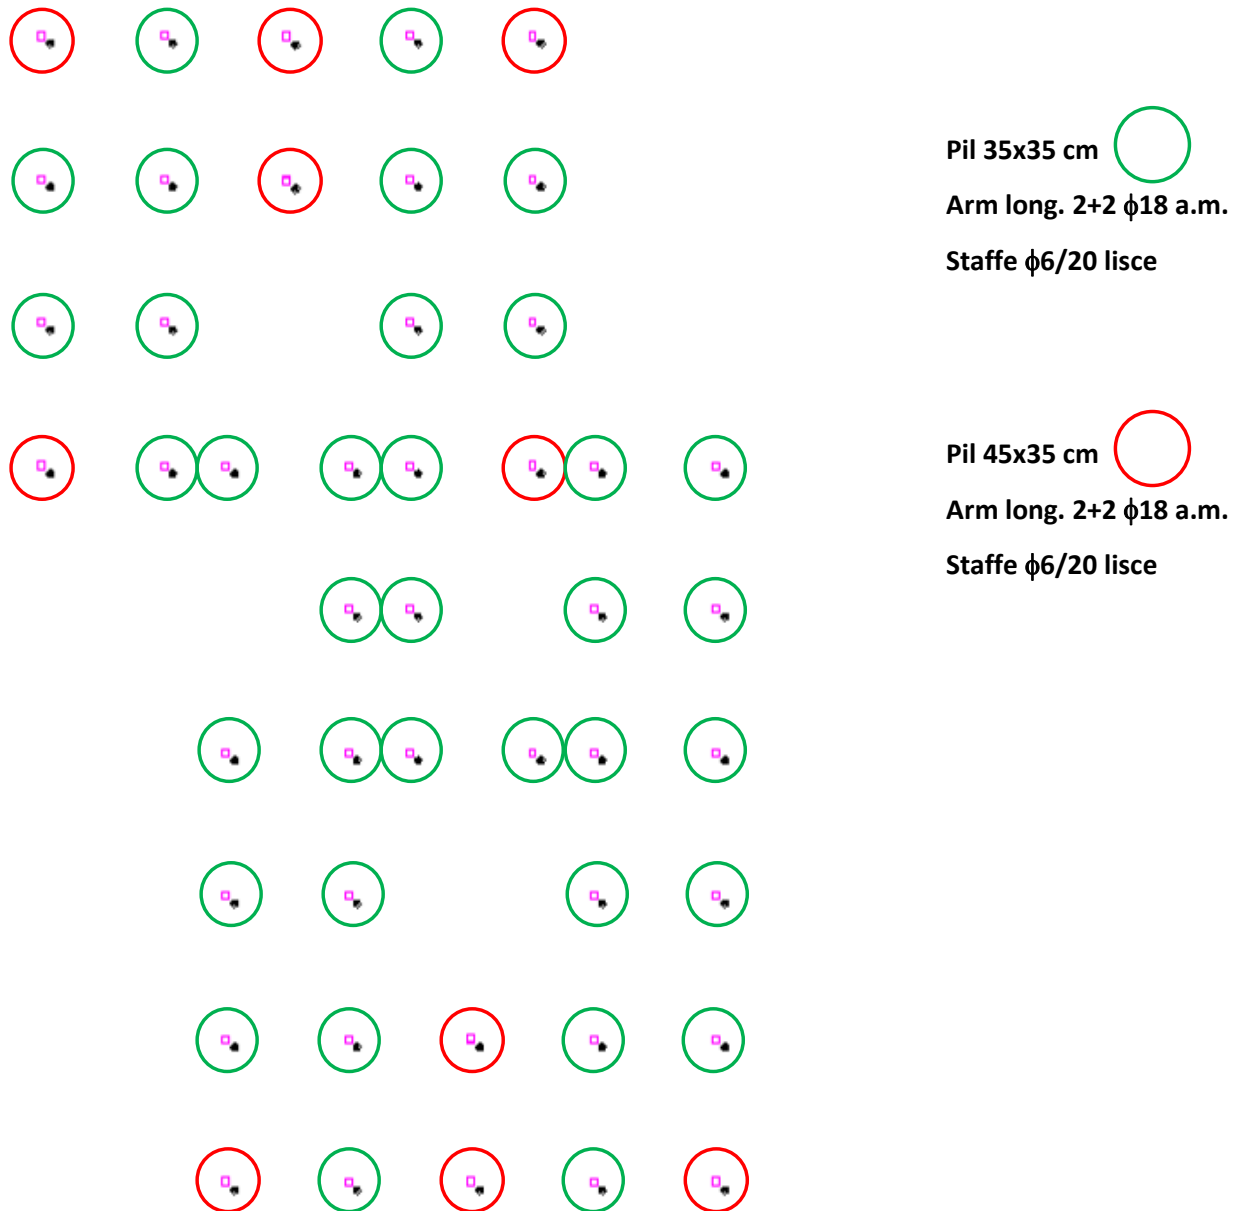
Pianta Livello 2, con indicazione delle tipologie di sezione dei pilastri
